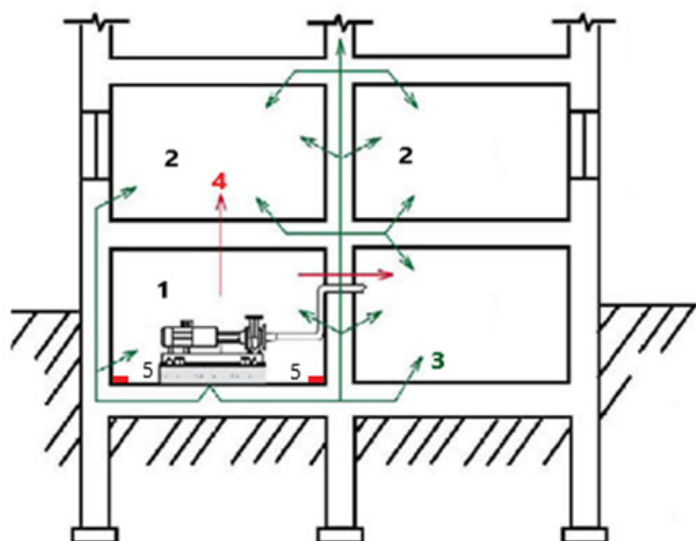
Схема установки насоса водоснабжения в помещении насосной жилого здания: 1 – помещение с установленным насосом системы водоснабжения; 2 – жилые помещения здания; 3 – передача структурного шума; 4 – передача воздушного шума; 5 – демпферная лента
